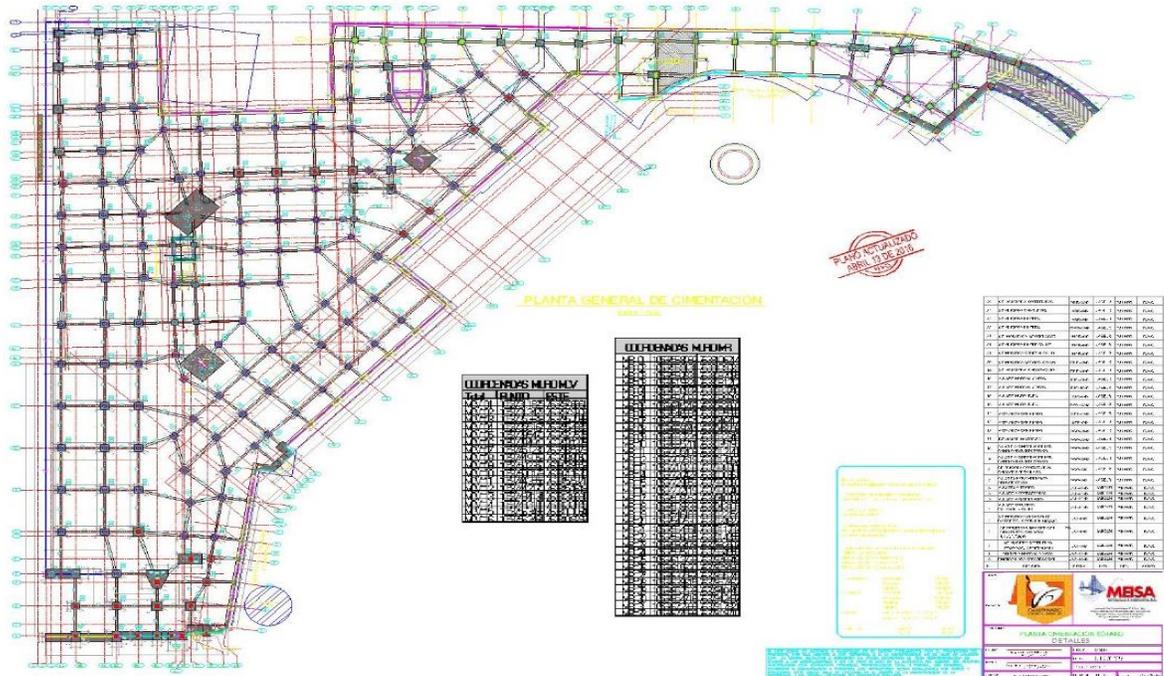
Plano de cimentación. (Fuente: Diseño estructural MEISA)
